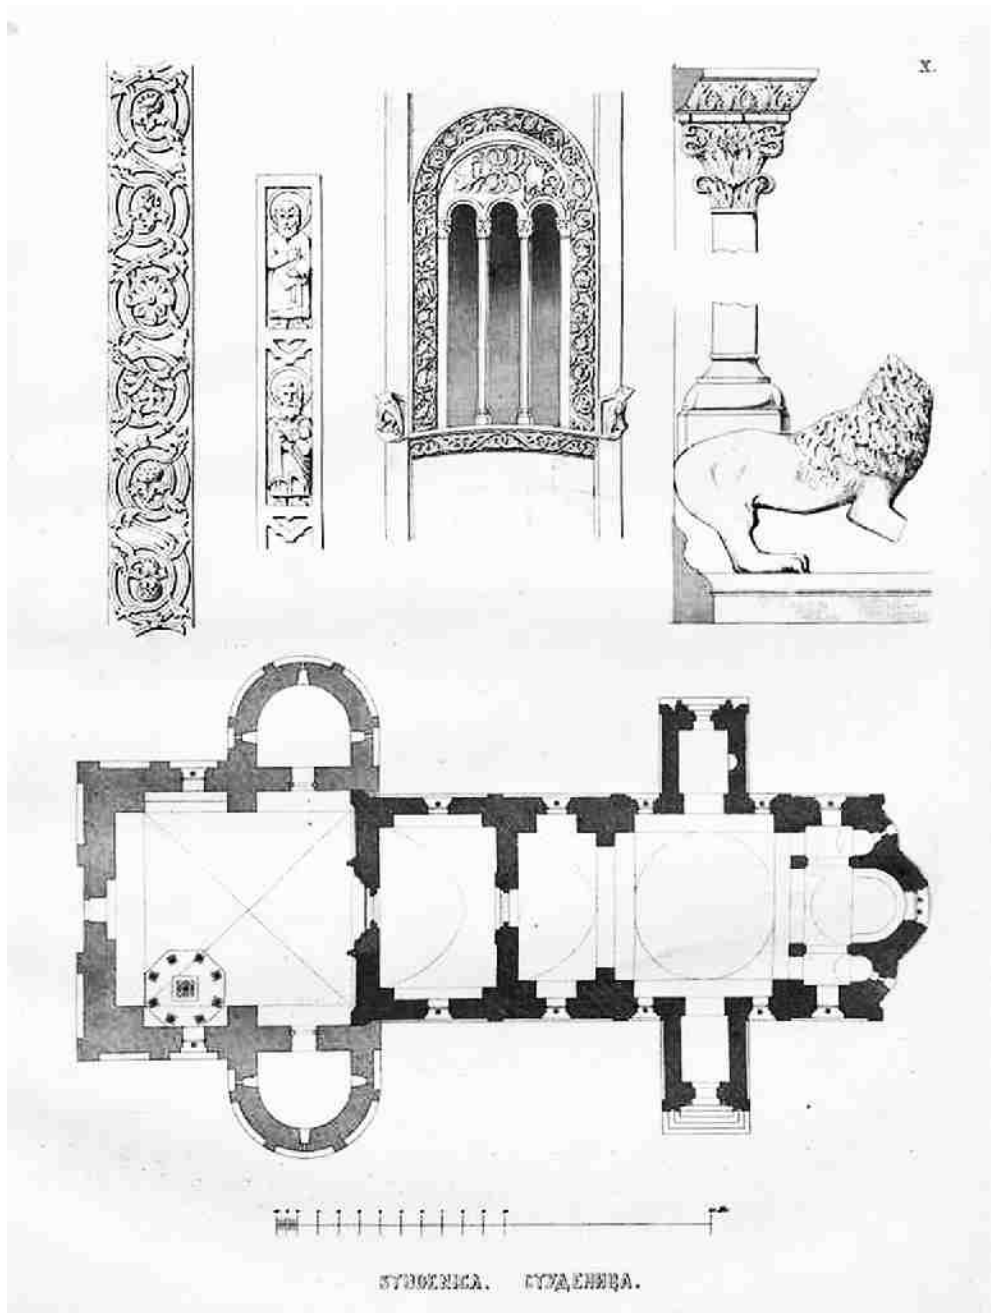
Studenica-Klosterkirche bei Kraljevo, 13. Jh. Grundriss und Details aus Kanitz 1862, Tafel X.
